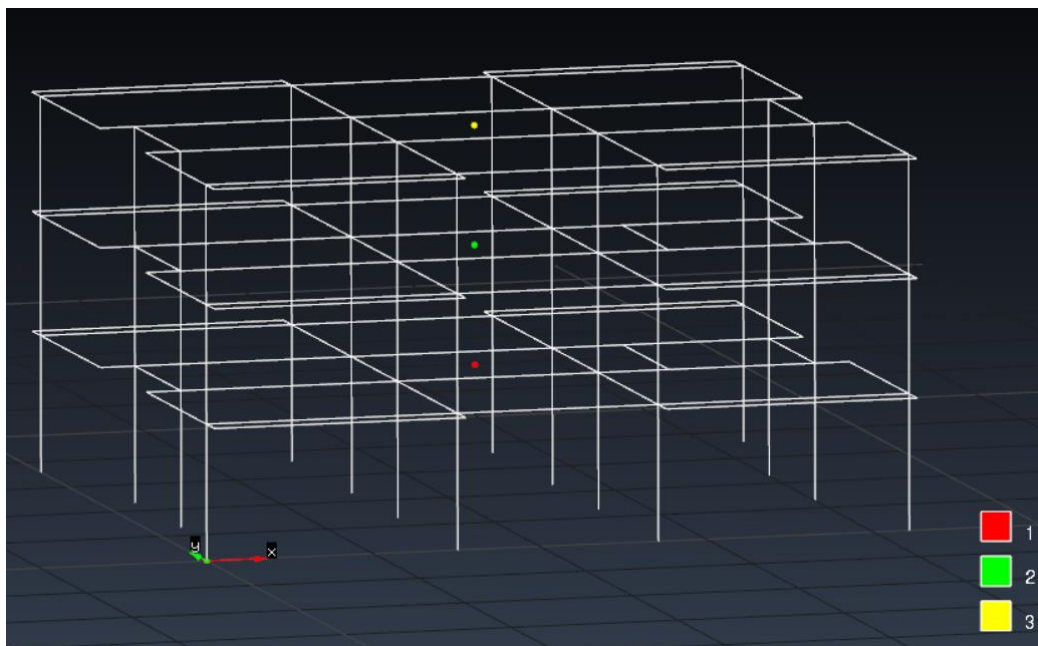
Identificación de los nodos maestros de cada forjado de la estructura. Rojo: Forjado de planta primera. Verde: Forjado de planta segunda. Amarillo: Forjado de cubierta. (Fuente: GiD)
